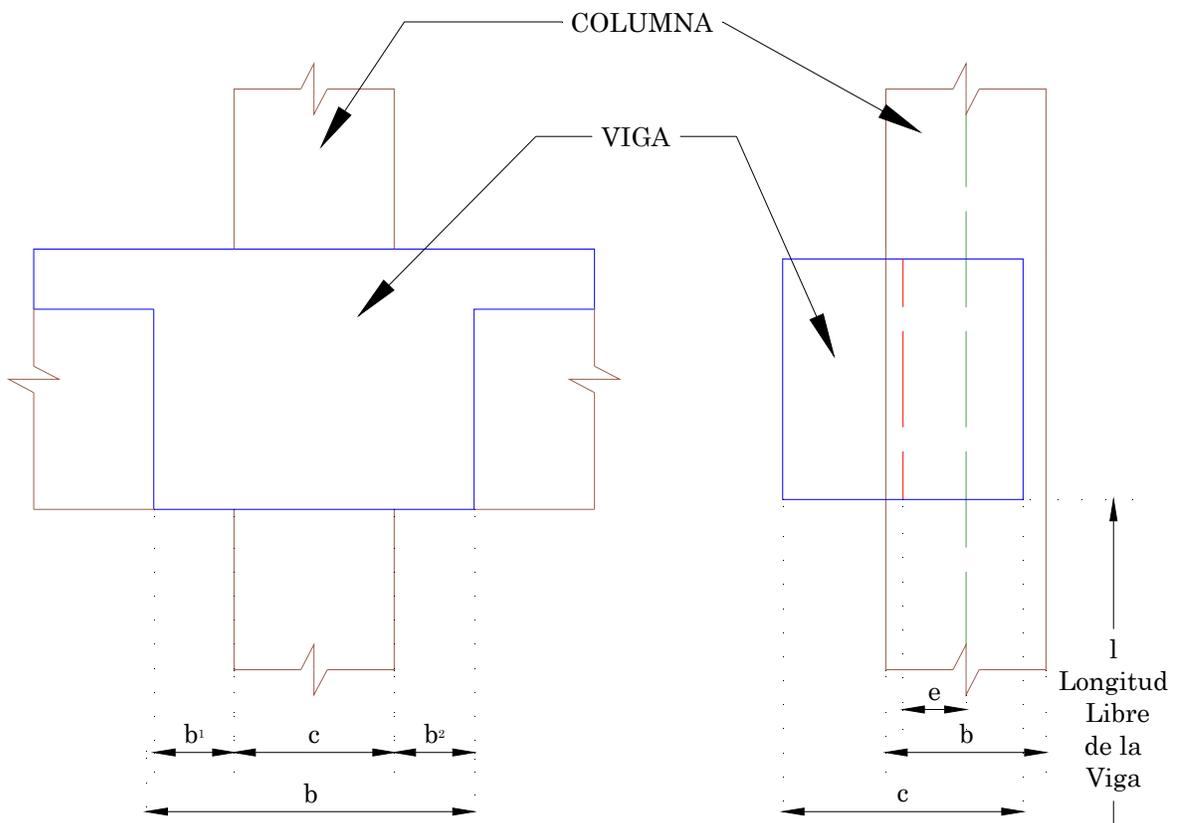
Requisitos Geometricos para Vigas de Marcos de Concreto
